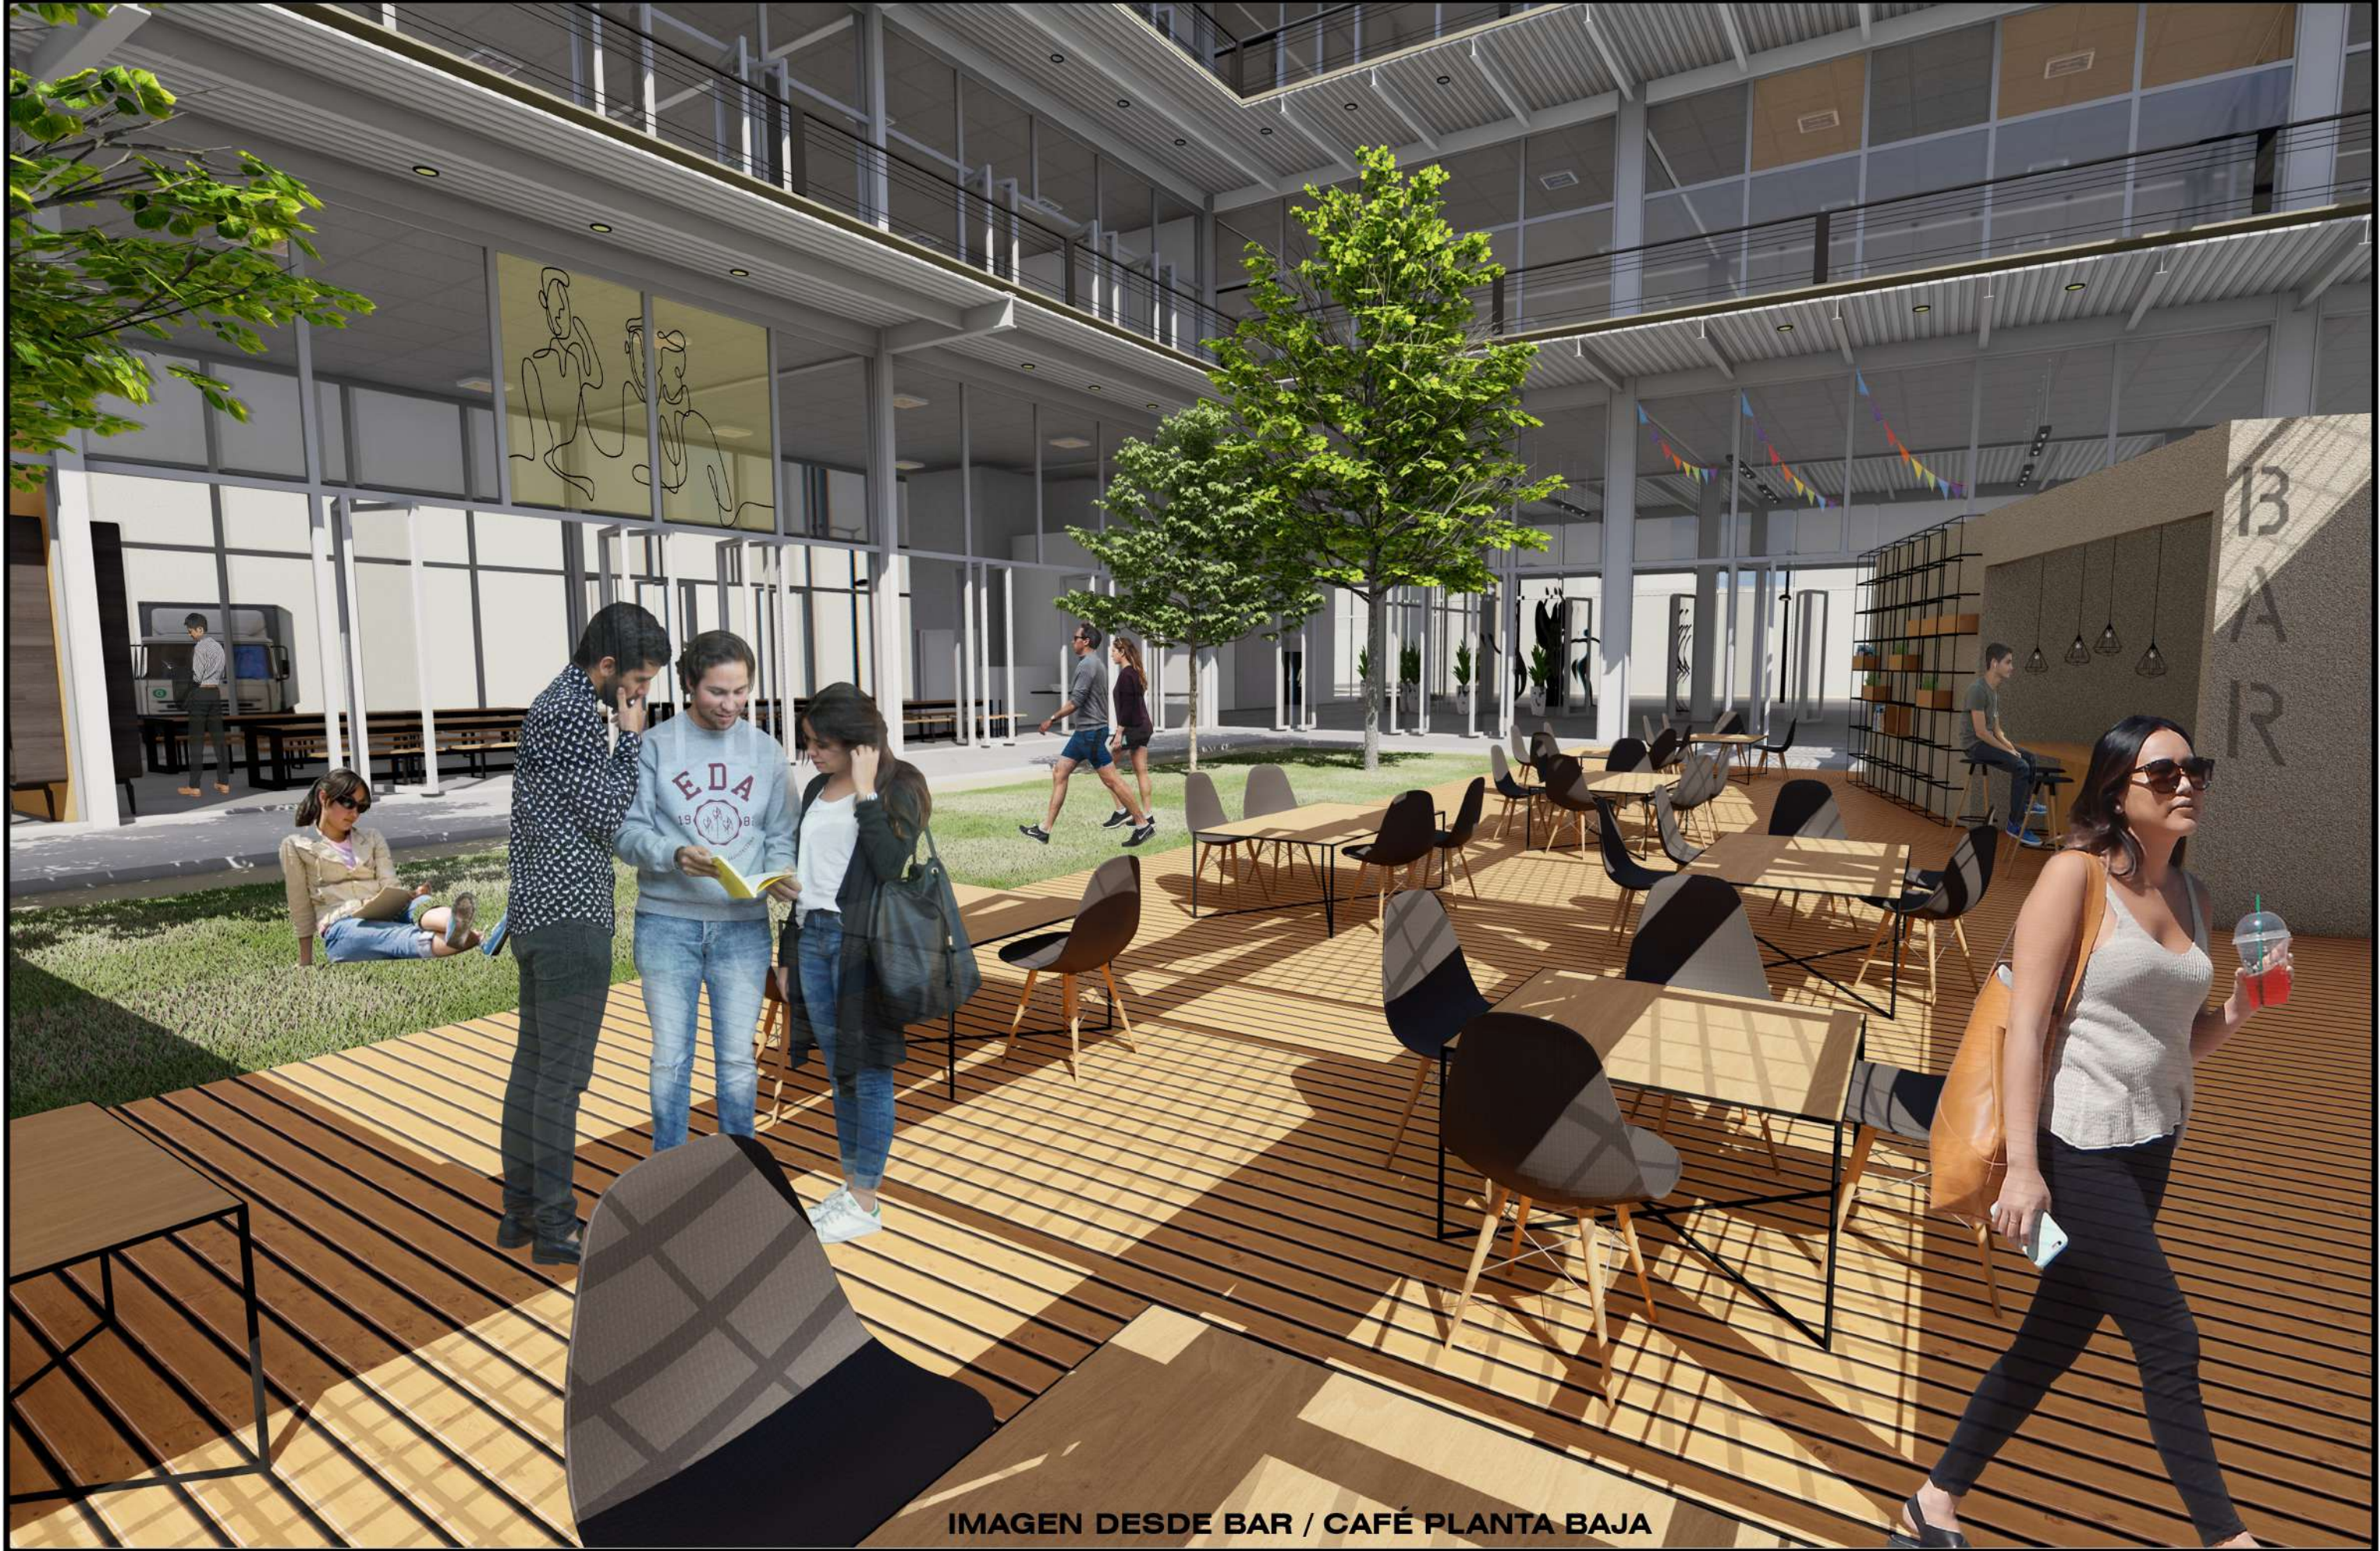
IMAGEN DESDE BAR / CAFÉ PLANTA BAJA
